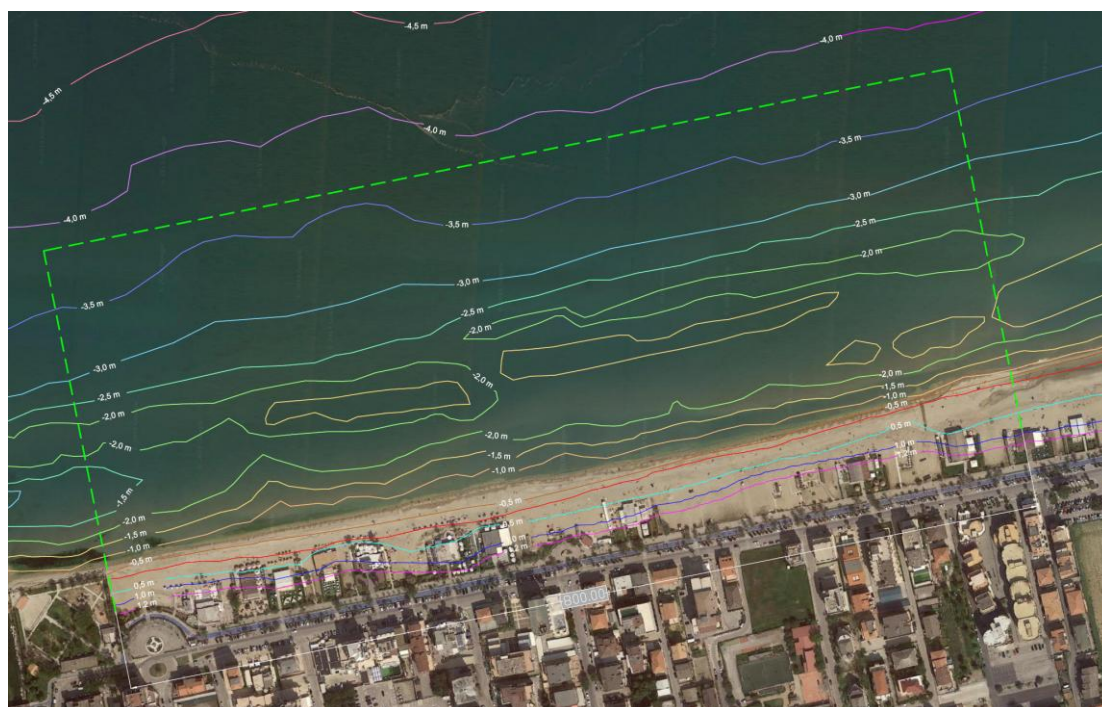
Estratto TAV. 10-b.3 Planimetria stato di fatto Alba Adriatica
